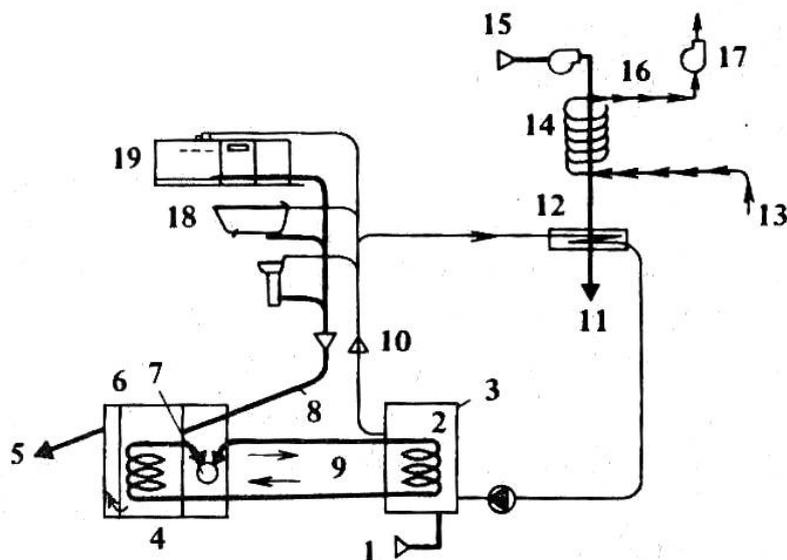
Схема использования теплоты сбросных бытовых вод и вентиляционного воздуха
